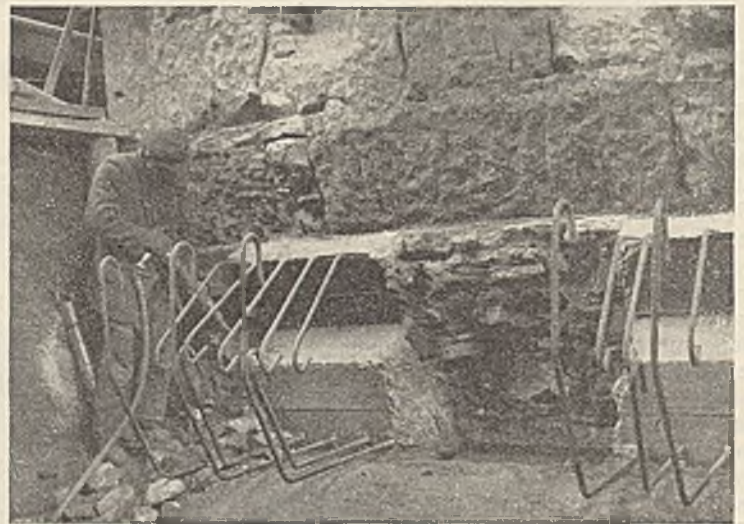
Viadukt Klähäm. Eisenbetondruckstempel unter den alten Pfeilern.
